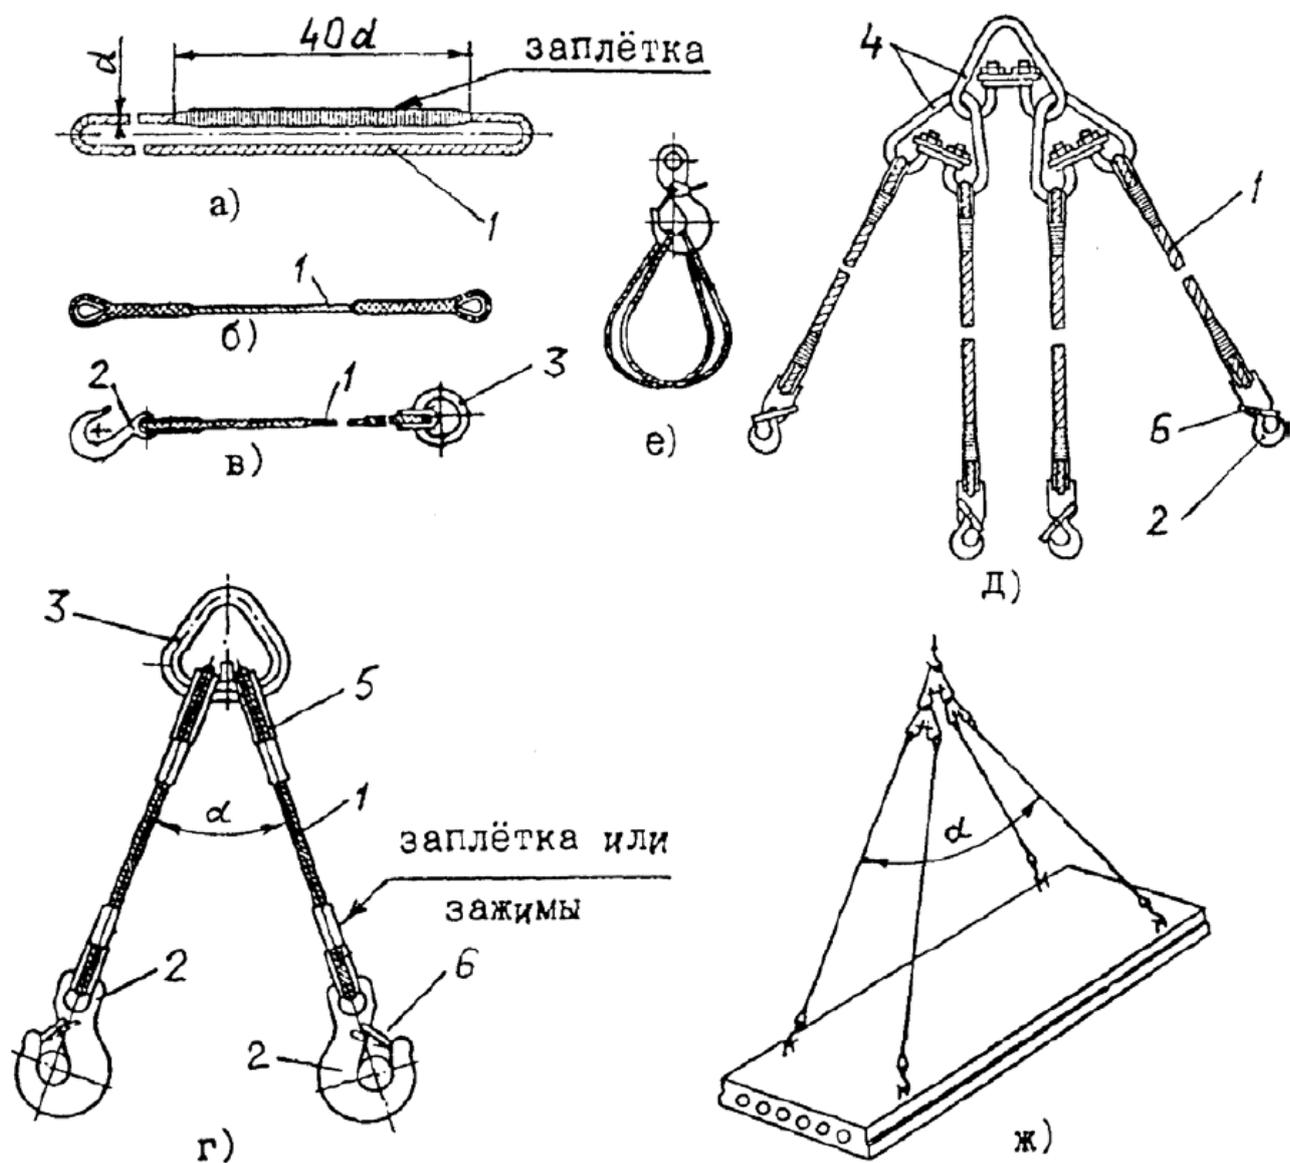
Стропы канатные: а – типа СКК; б – типа СКП; в – типа 1СК; г – типа 2СК; д – типа 4СК; е – схема подвески на крюк кольцевого стропа; ж – схема подвески плиты стропом типа 4СК; 1 – канат (ветвь каната); 2 – чалочный крюк; 3 – звено навесное неразъемное; 4 – звено навесное разъемное; 5 – коуш; 6 – предохранительный замок крюка
